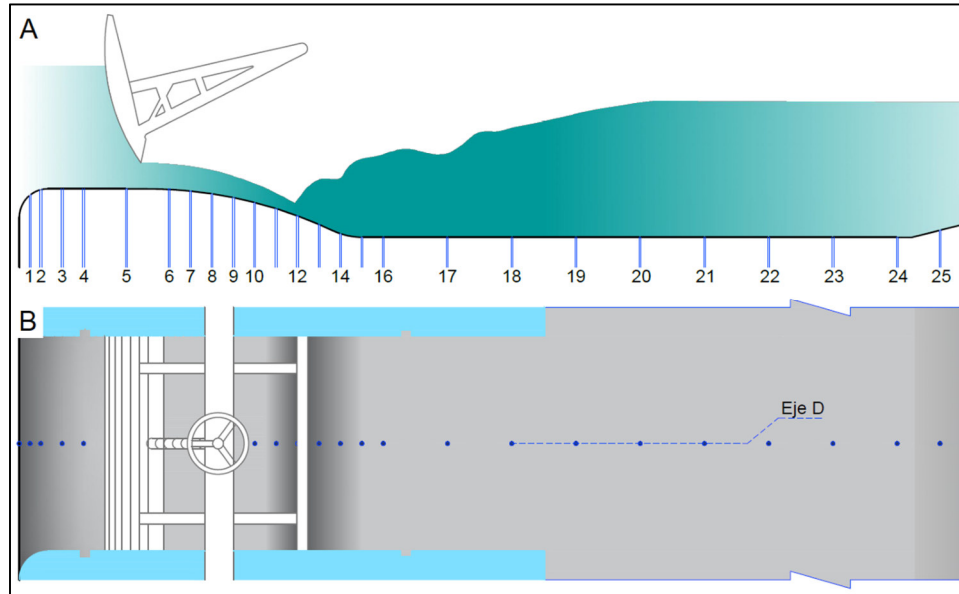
Esquema de distribución de piezómetros en corte (A) y planta (B).
